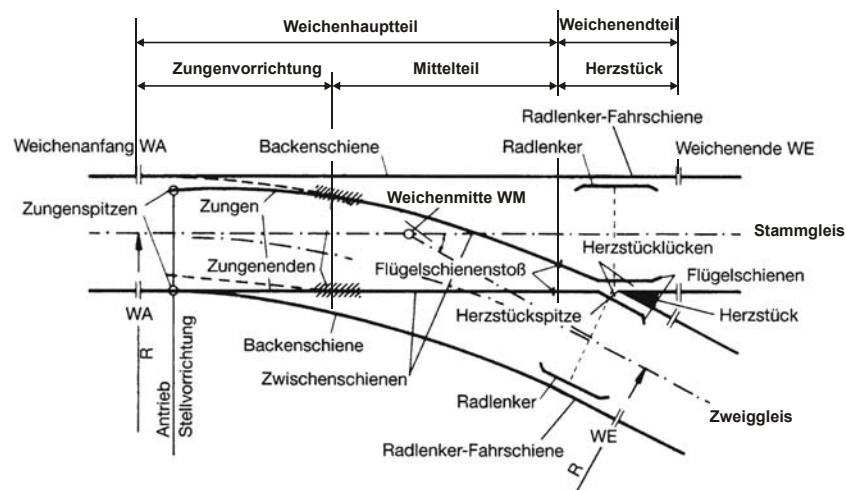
Darstellung einer Weiche im Grundriss
